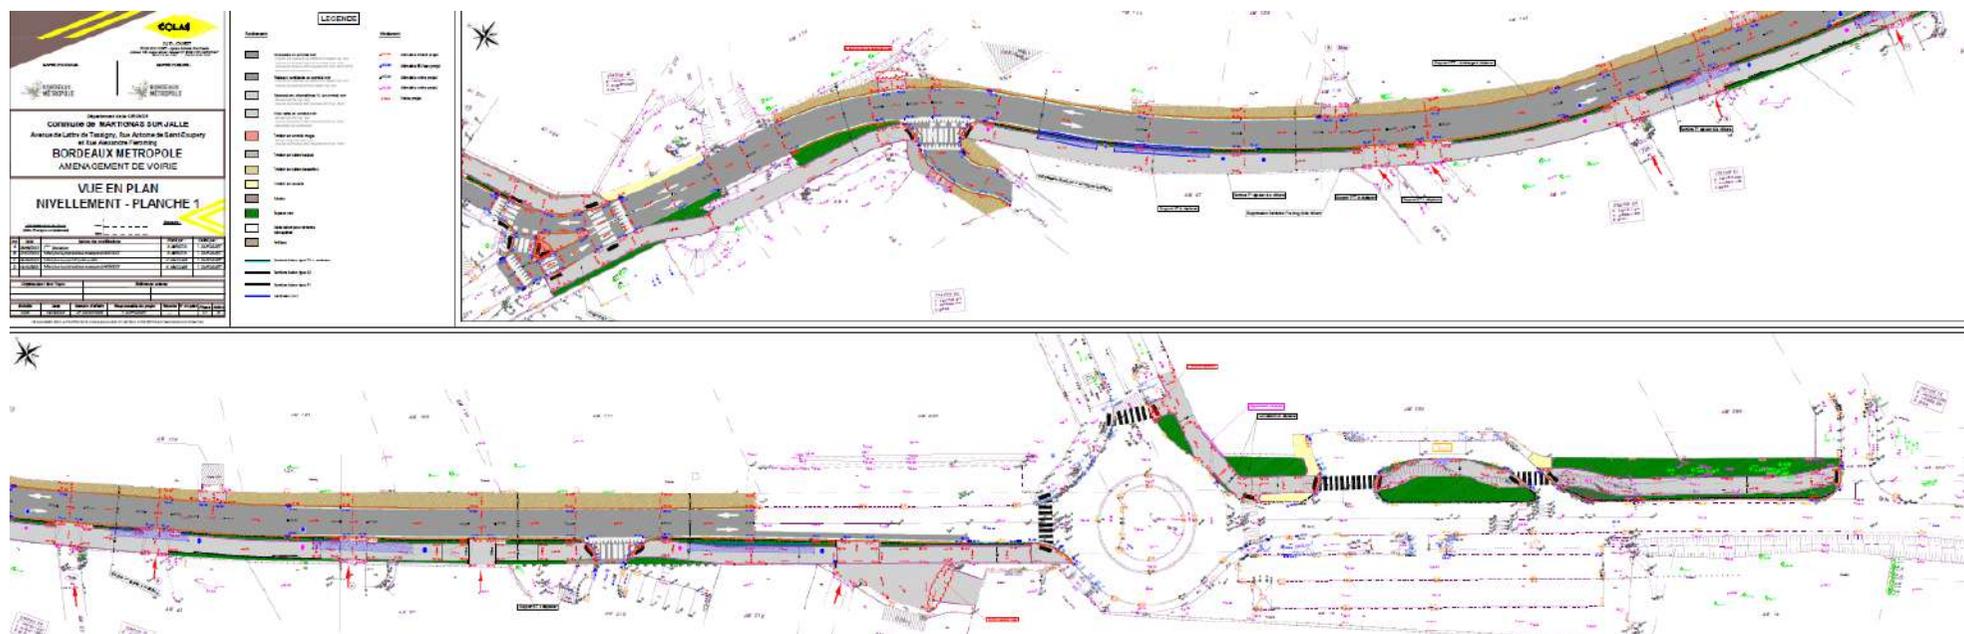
Plan d'exécution de l'aménagement du secteur "zoom 3"
